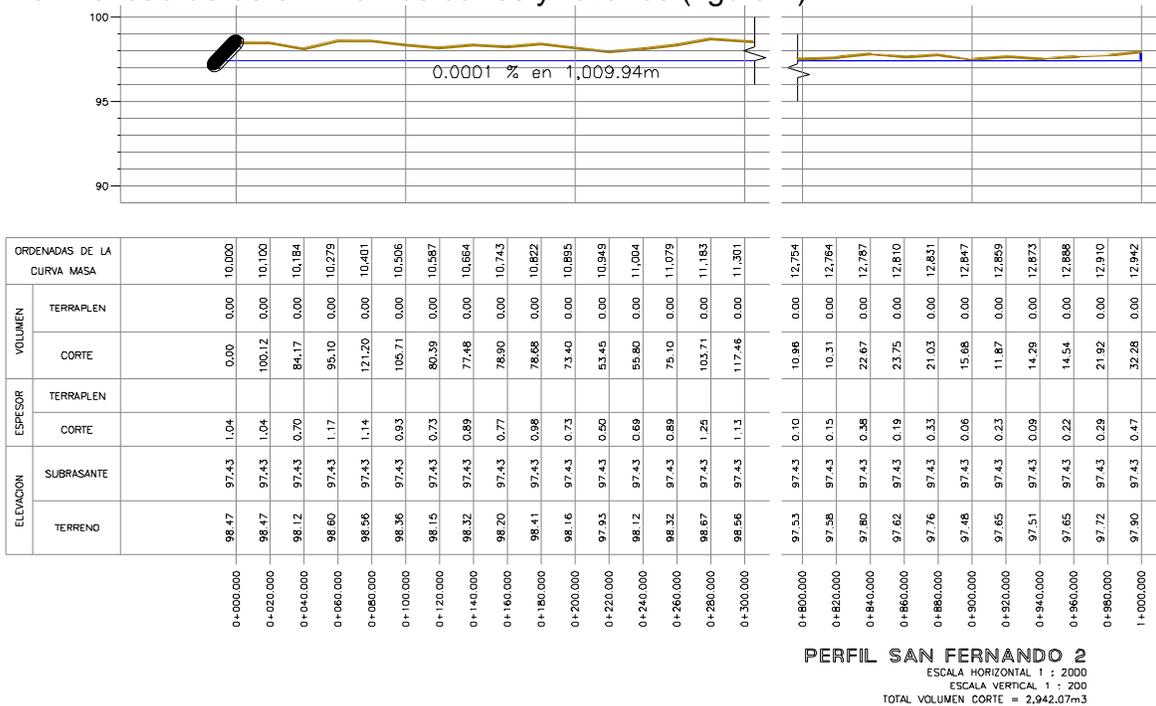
Perfil longitudinal del dren san Fernando con cortes y rellenos, volumen total.
